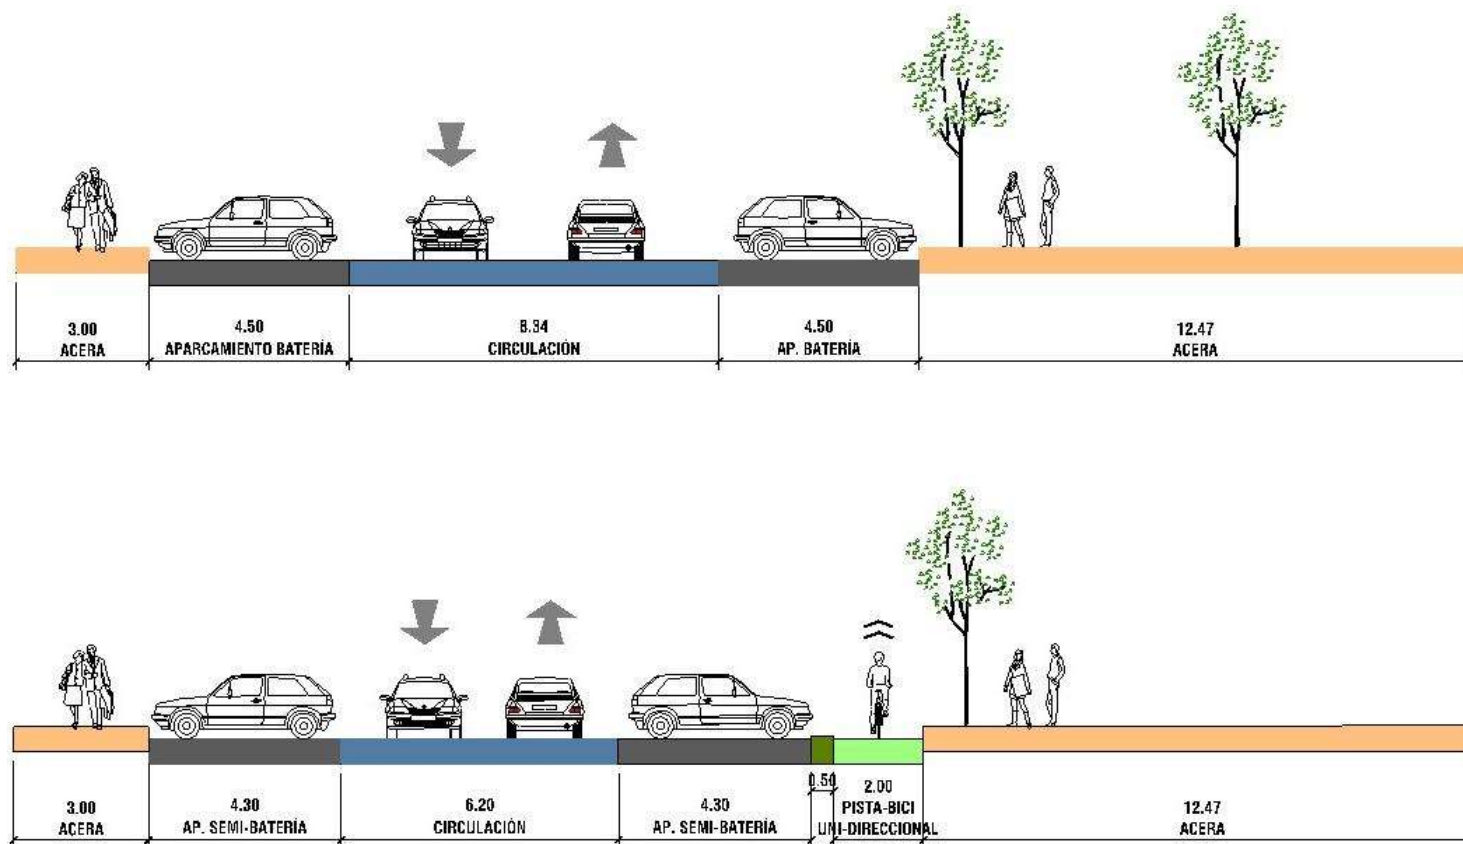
Sección tipo A propuesta en Avenida de la Sierra. Fuente: DOYMO.
